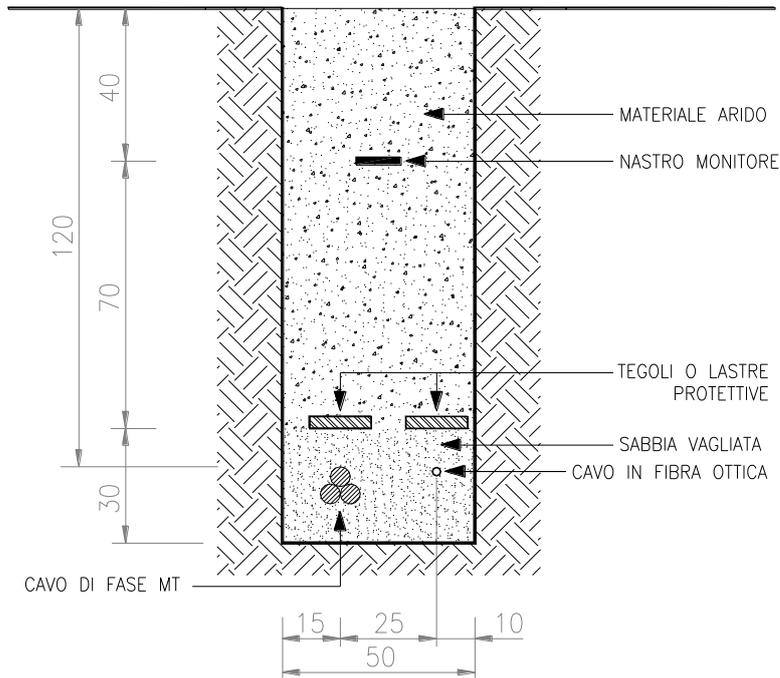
Sezione tipo posa cavo MT con n° 1 linea
